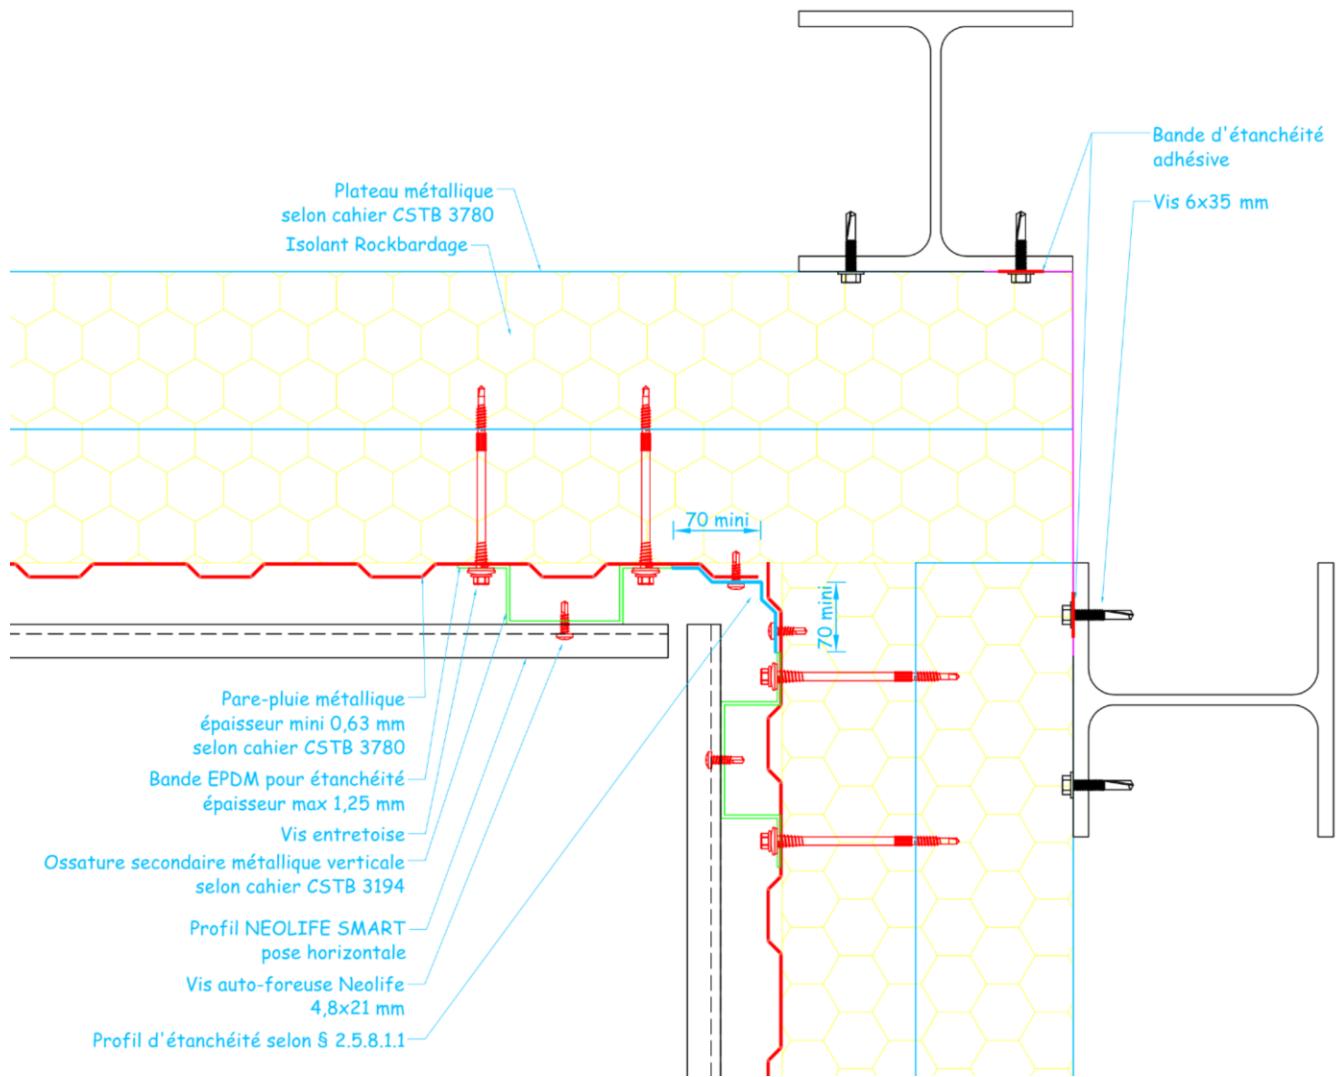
Arrêt sur acrotère avec profil de reprise de charge (coupe verticale 2)
